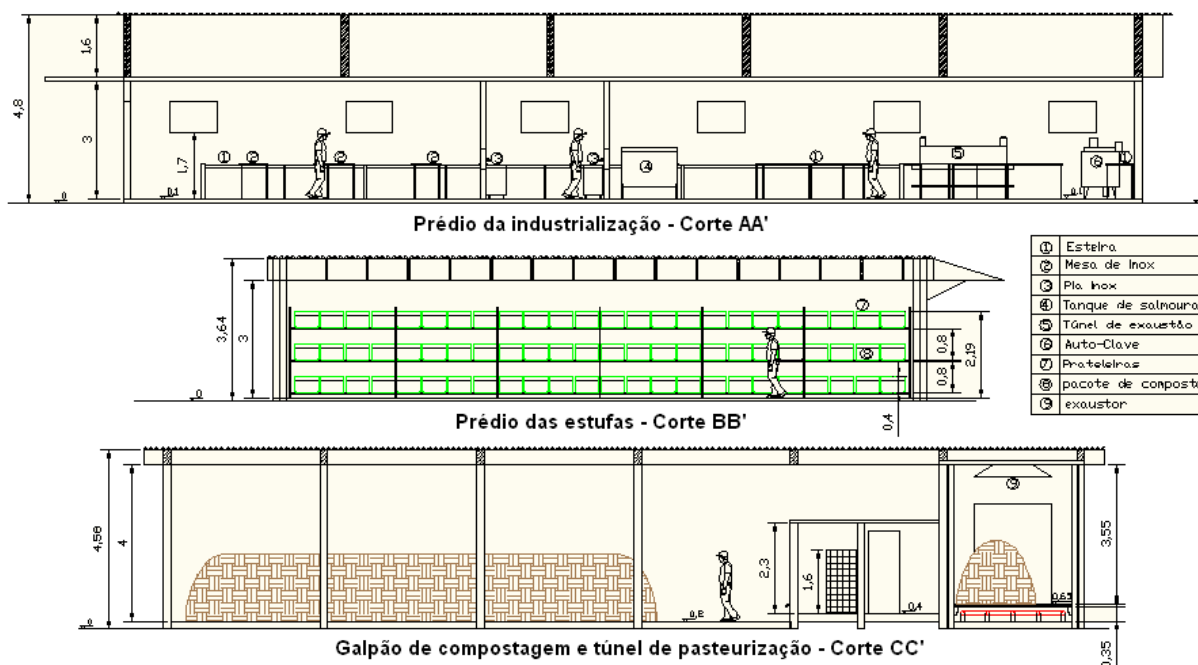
Planta baixa e cortes das instalações para cultivo e processamento de cogumelos
